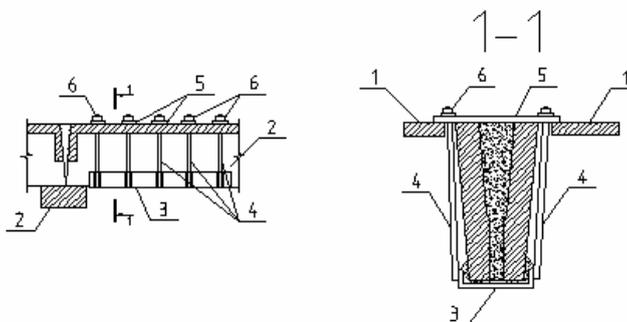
Усиление опорной зоны ребристых плит установкой предварительно напряженных хомутов: 1 – усиливаемые плиты; 2 – стропильная конструкция; 3 – обрезок швеллера, устанавливаемый на цементно-песчаном растворе; 4 – поперечные хомуты из арматурной стали, установленные в просверленные отверстия и приваренные к швеллеру; 5 – поперечная планка из стальной полосы с отверстиями для хомутов; 6 – гайки для создания предварительного напряжения в хомутах (после натяжения гайки заваривают или устанавливают контргайки)
